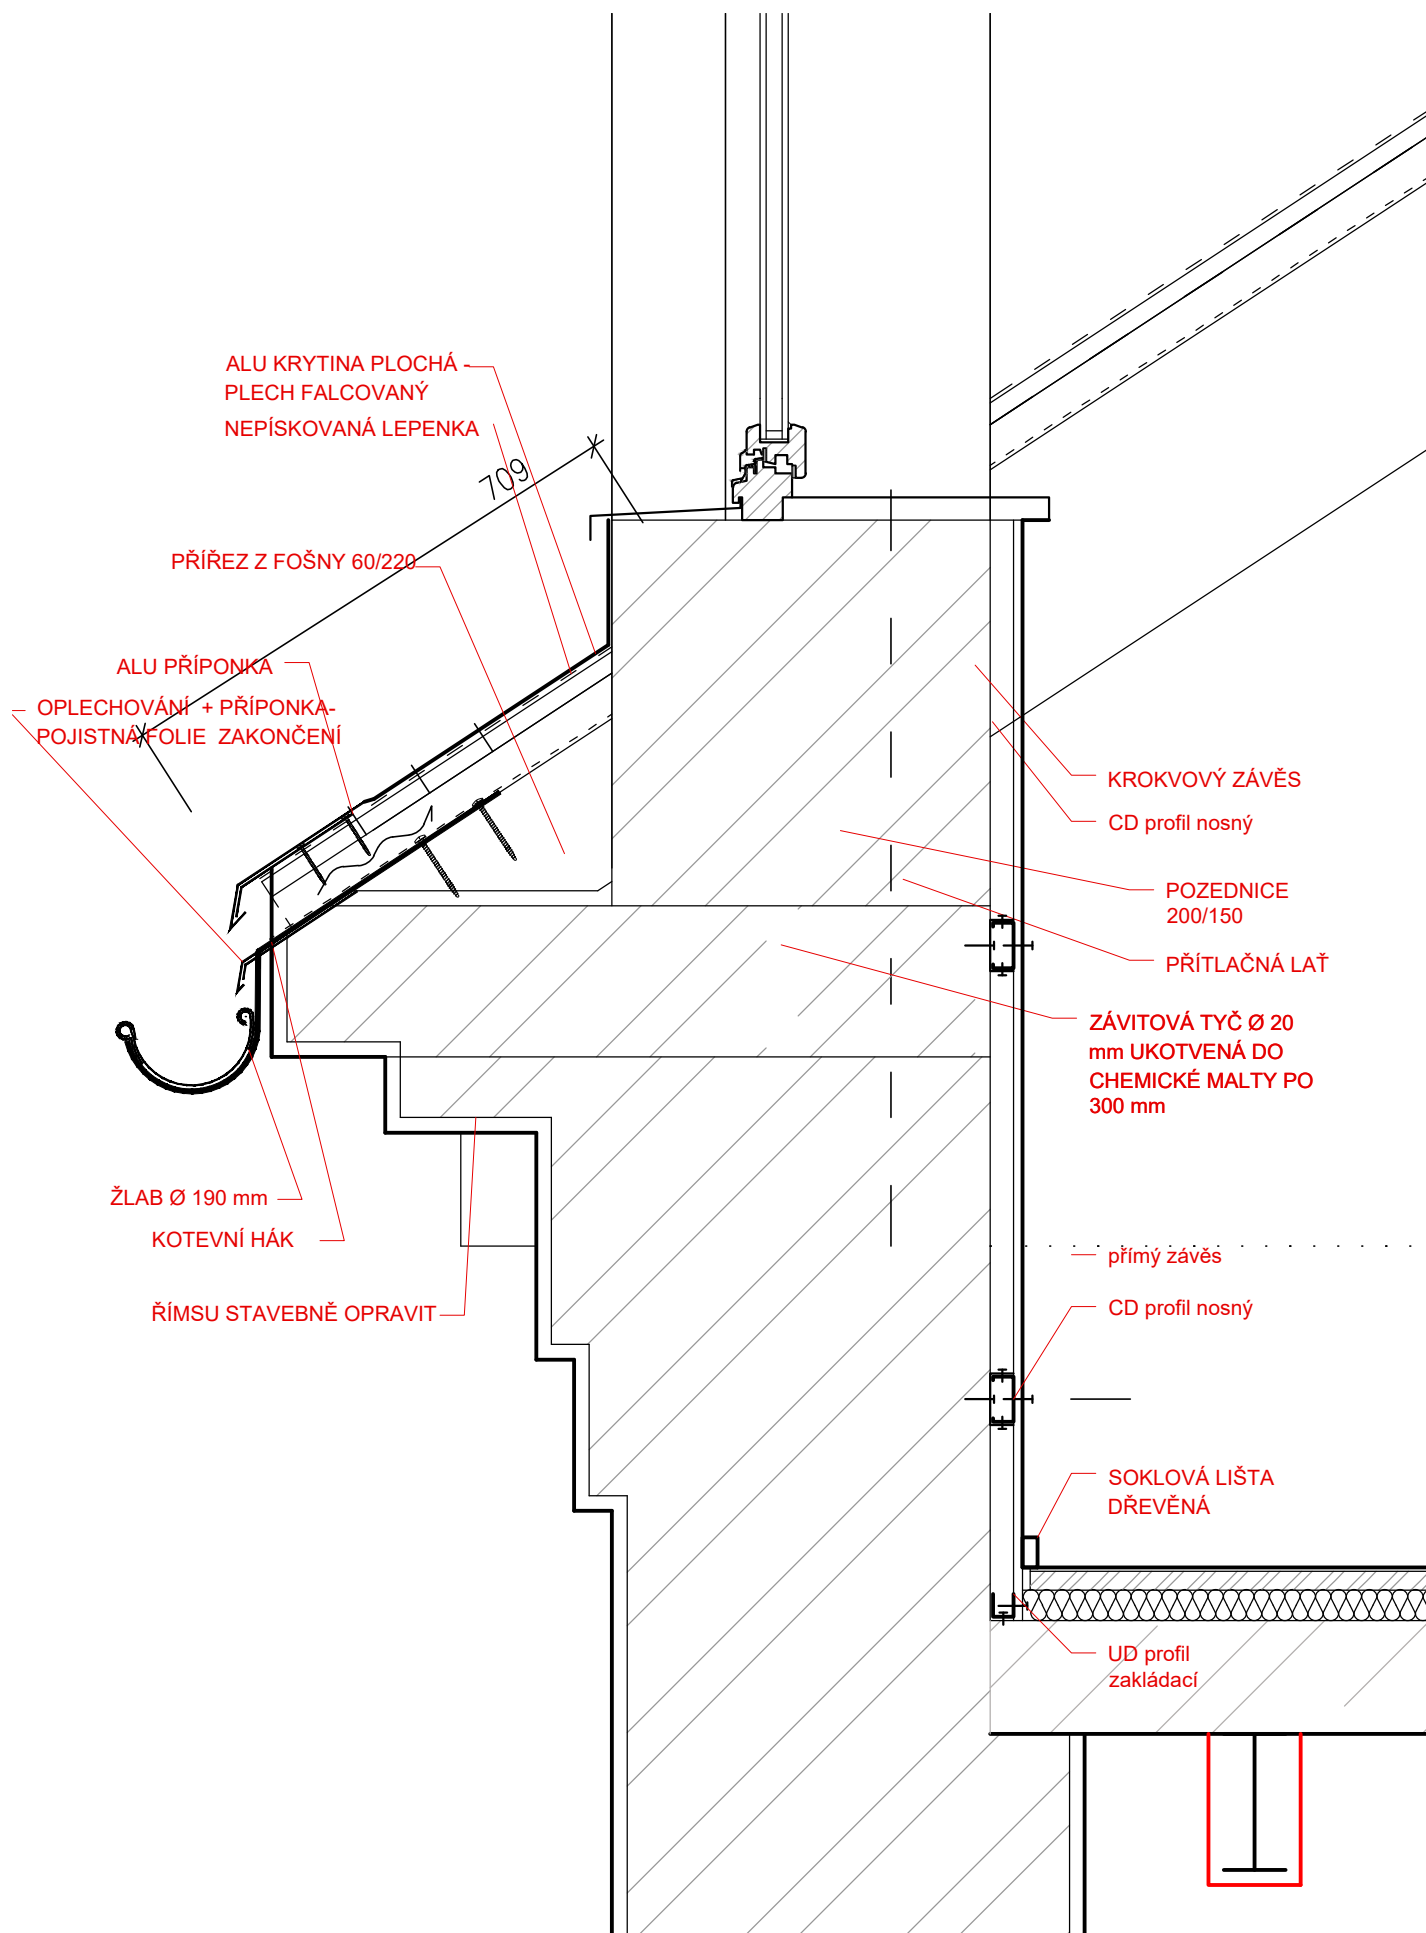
DETAIL – PŘÍČNÝ ŘEZ VIKÝŘEM
